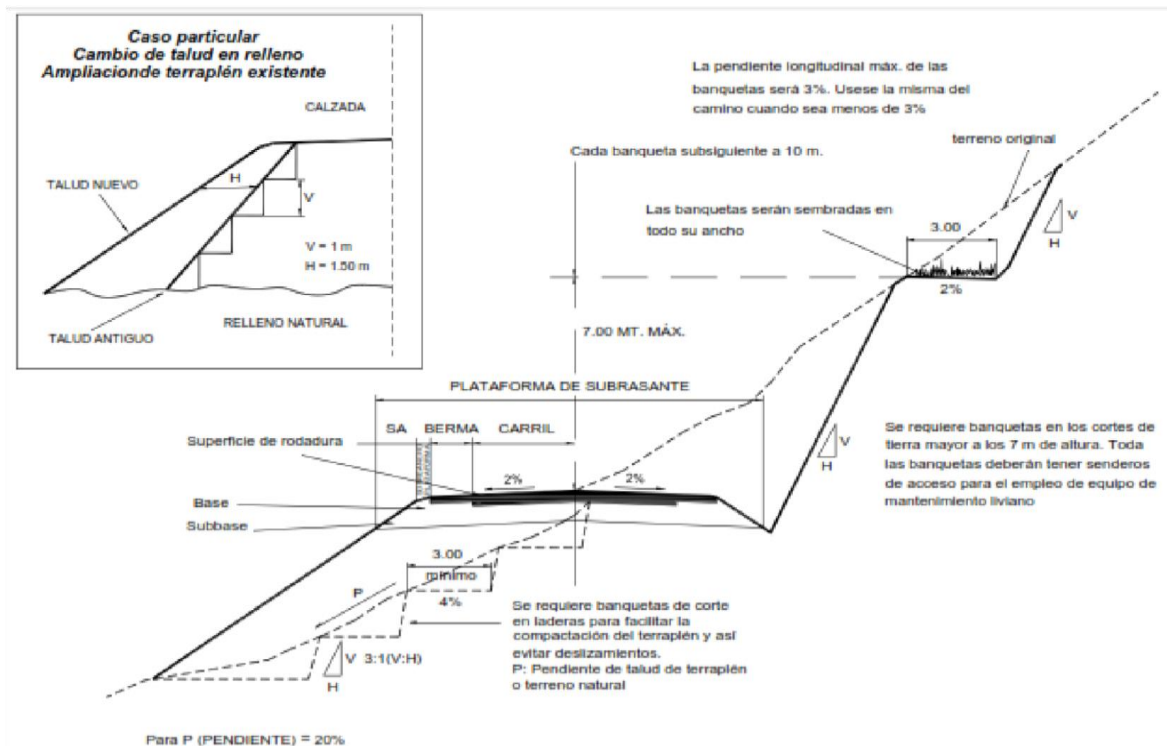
Sección Tipo en tangente con banquetas de relleno.
